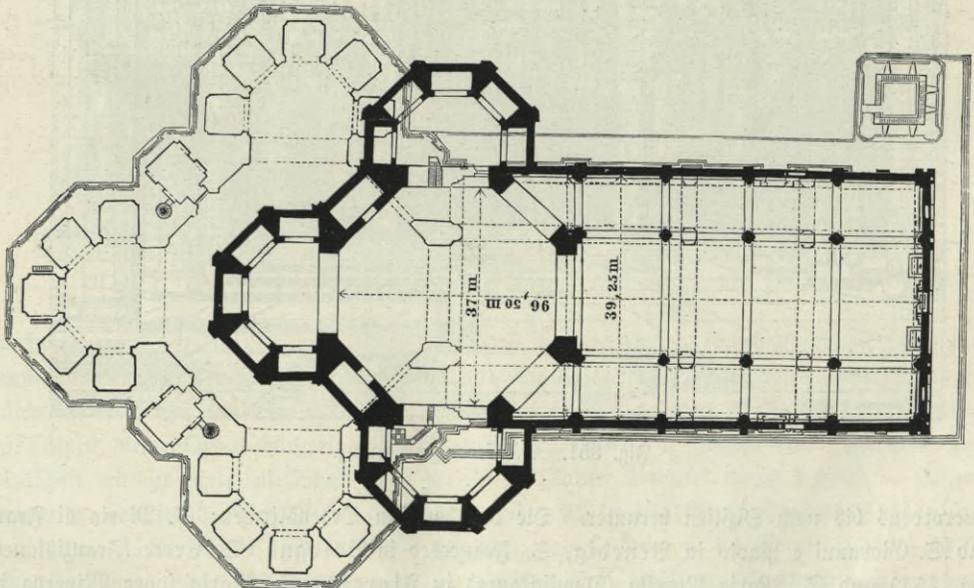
Grundriß des Domes zu Florenz. (Die dunklere Zeichnung bezeichnet den ursprünglichen Plan.)
